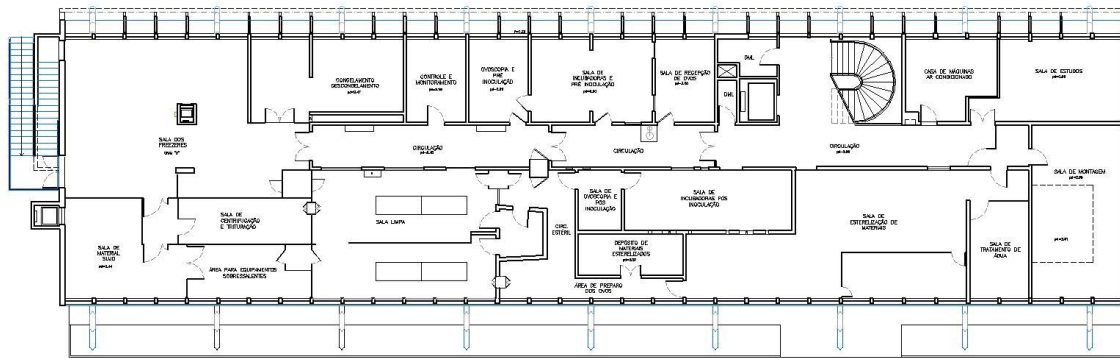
Laboratório da Febre Amarela: planta do 2º pavimento, 2016. Fonte: acervo técnico de BioManguinhos
